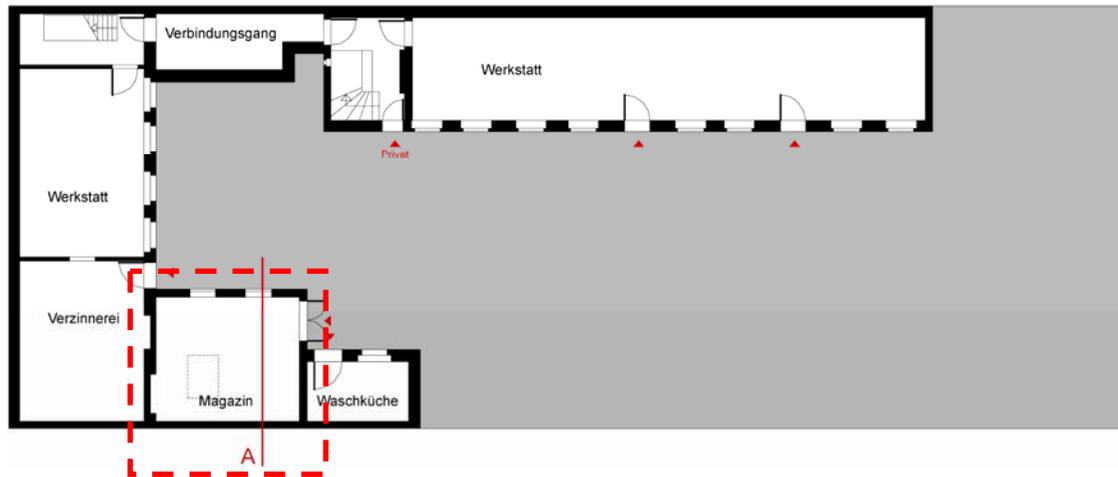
Grundriss Erdgeschoss mit Magazinzubau
